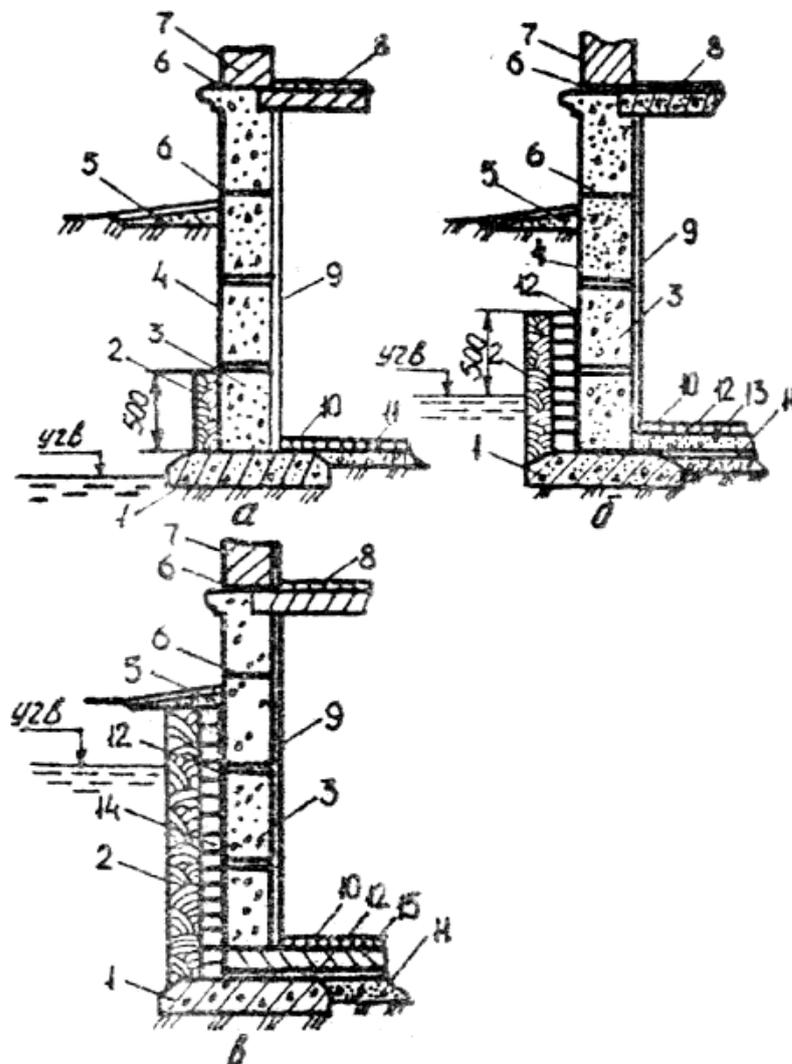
Гидроизоляция в зданиях с подвалами : а - при уровне грунтовых вод ниже отметки пола подвала; б - при уровне грунтовых вод выше отметки пола подвала на 500 мм; в - при уровне грунтовых вод более 500 мм; 1 - железобетонная подушка фундамента; 2 - мягкая глина; 3 - стена подвала; 4 - битумная мастика в два слоя; 5 - отсыпка; 6 - горизонтальная гидроизоляция; 7 - стена; 8 - подвальное перекрытие; 9 - штукатурка; 10 - пол; 11 - бетонная подготовка; 12 - рулонная гидроизоляция; 13 - подготовка под полы; 14 - кирпичная стенка на цементном растворе; 15 - железобетонная стена; (уч В- уровень грунтовых вод)
